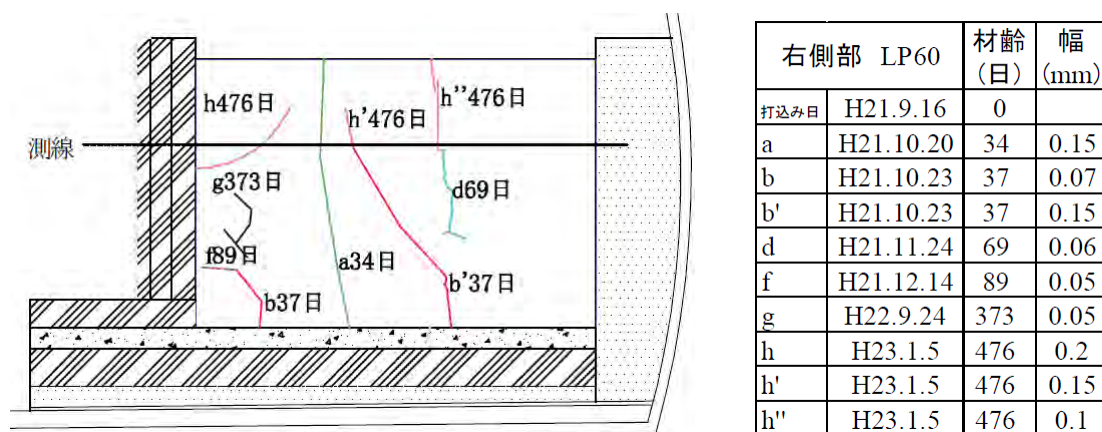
側部低拡散材（LP60 配合）のひび割れ状況（側面図）
